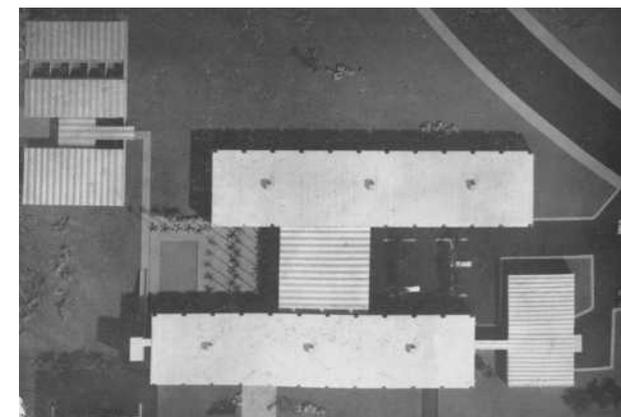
Vista da maquete, onde pode-se ver claramente a implantação planejada para o conjunto.
